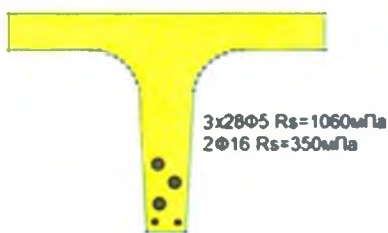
Основное армирование балок длиной 12 и 15 м с каркасным и смешанным армированием
